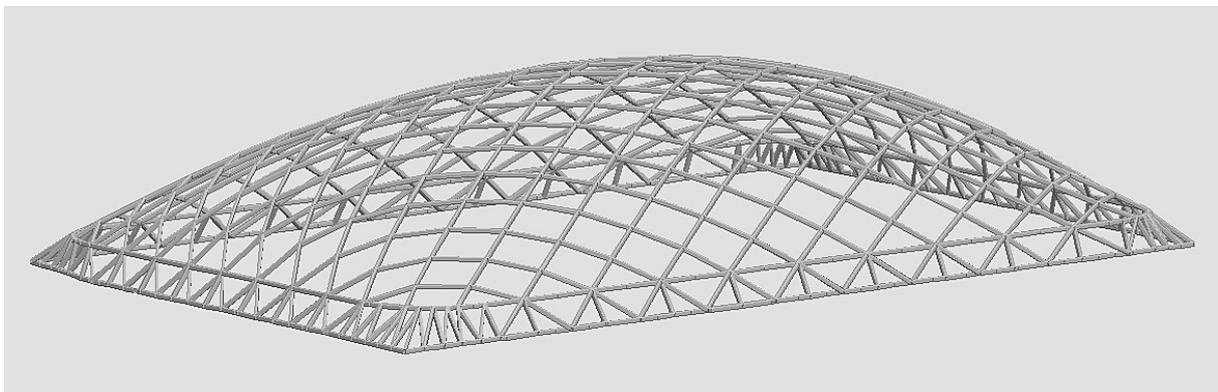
Strukturmodell der Stabwerkskuppel, bestehend aus Gitterschale und umlaufendem Randfachwerkträger an der Kuppelbasis
